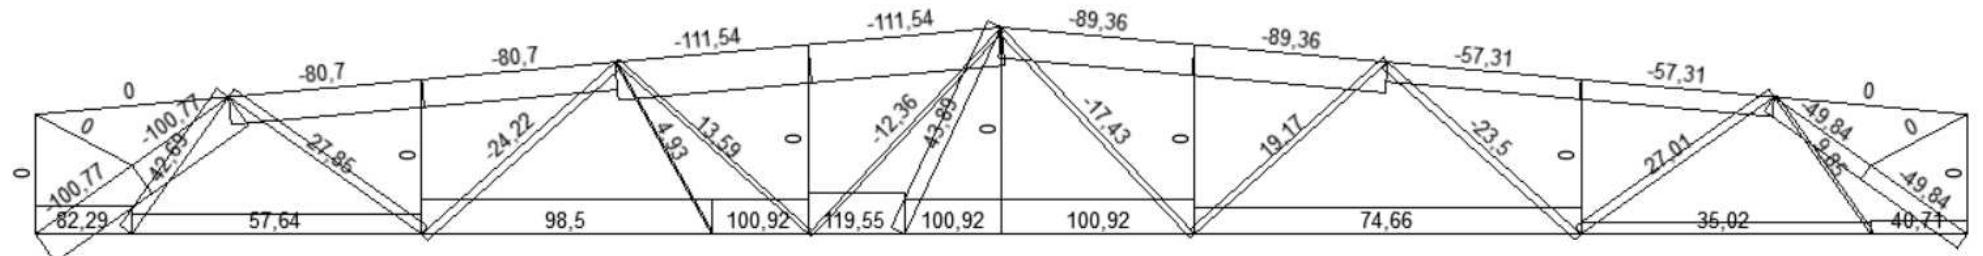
Эпюра внутренних усилий от первой комбинации крановой нагрузки
